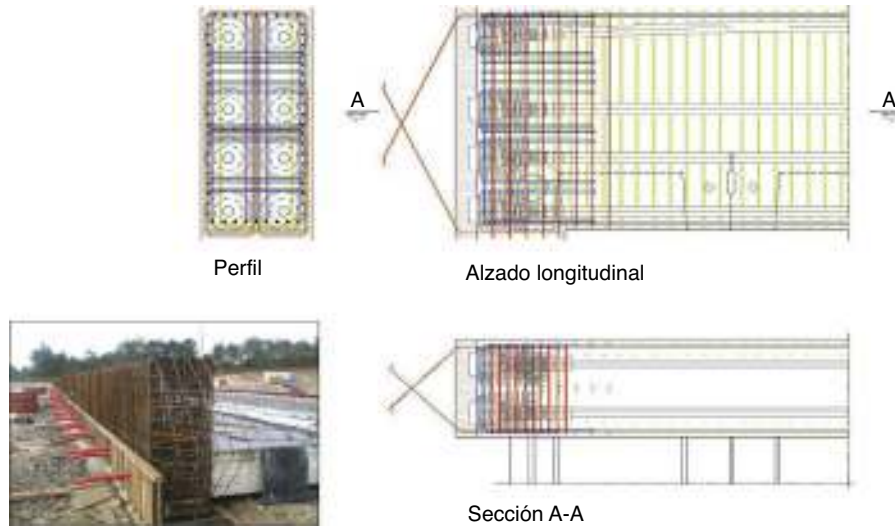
Armado de vigas peraltadas, donde se puede observar la gran cantidad de armado en zona de anclajes.
